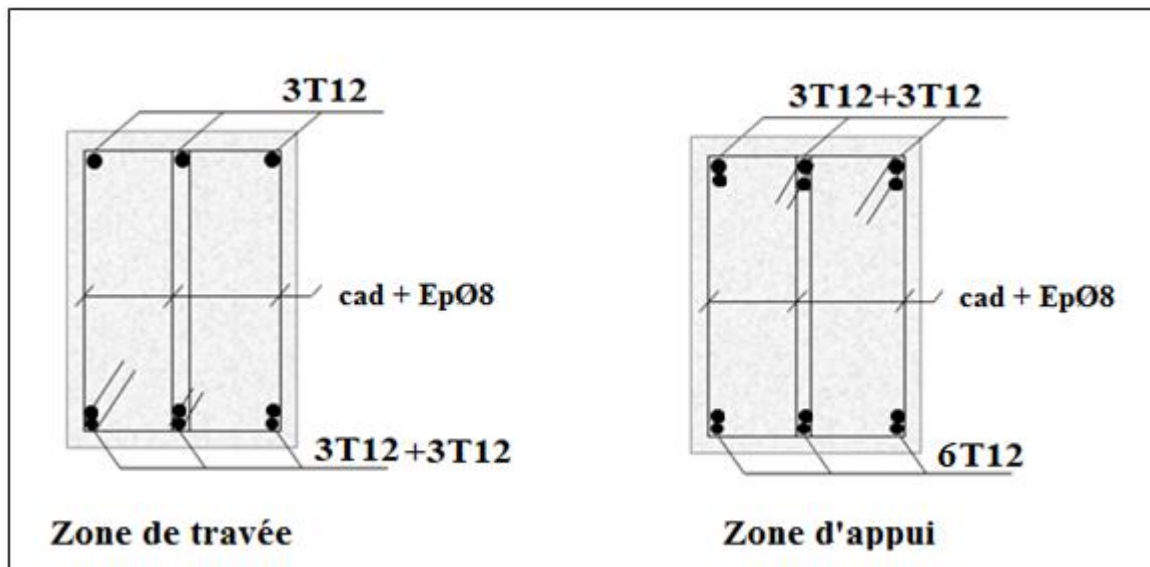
Schéma de ferrailage de la poutre secondaire.
